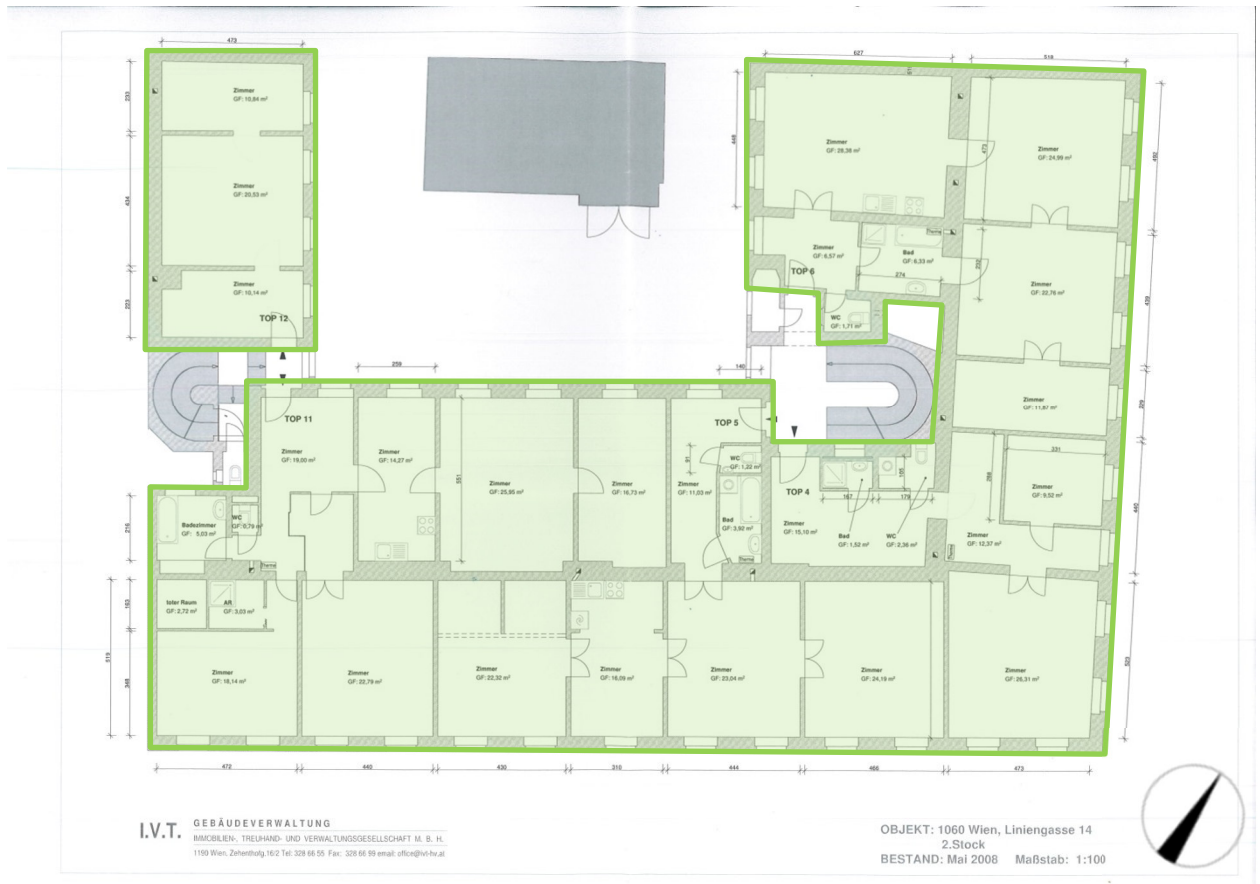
Grundriss 2. Stock mit Eintragung der thermischen Gebäudehülle – ohne Maßstab;
